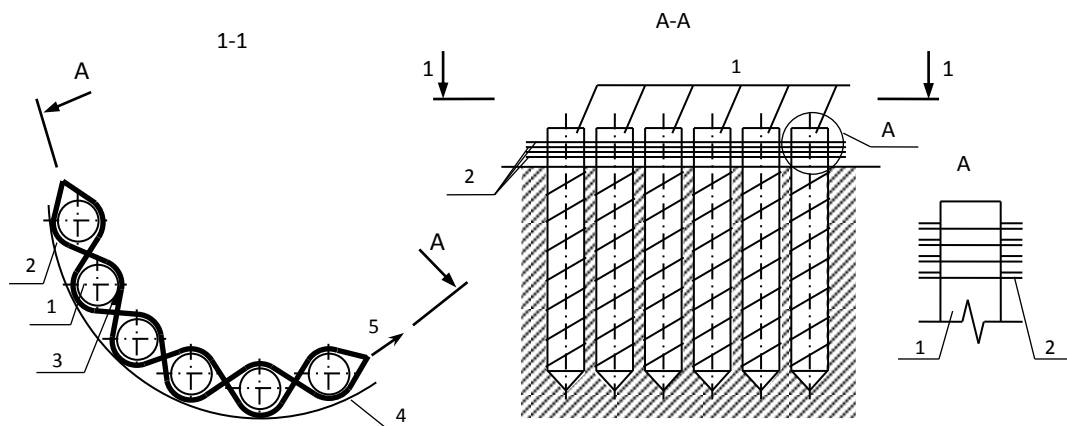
Спорудження обв'язочного поясу пального огороження за допомогою арматурних плітей: 1 – палі; 2 – обв'язочний пояс з арматурних плітей; 3 – натяжний клин; 4 – край котловану; 5 – напрямок натягу
